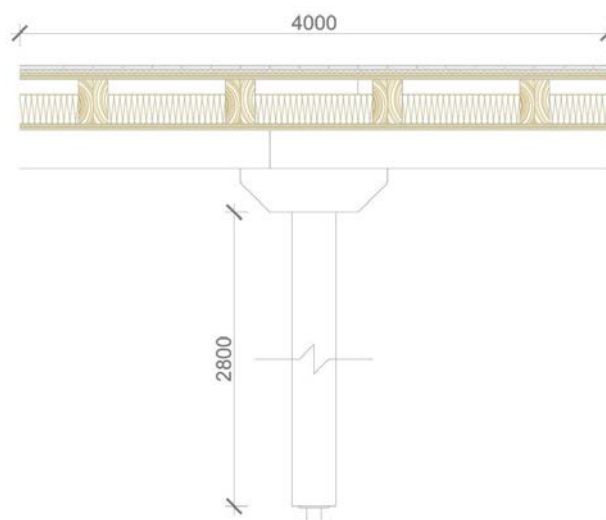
Esquema del pilar tipo propuesto para comparar las distintas maderas industrializadas a compresión.
